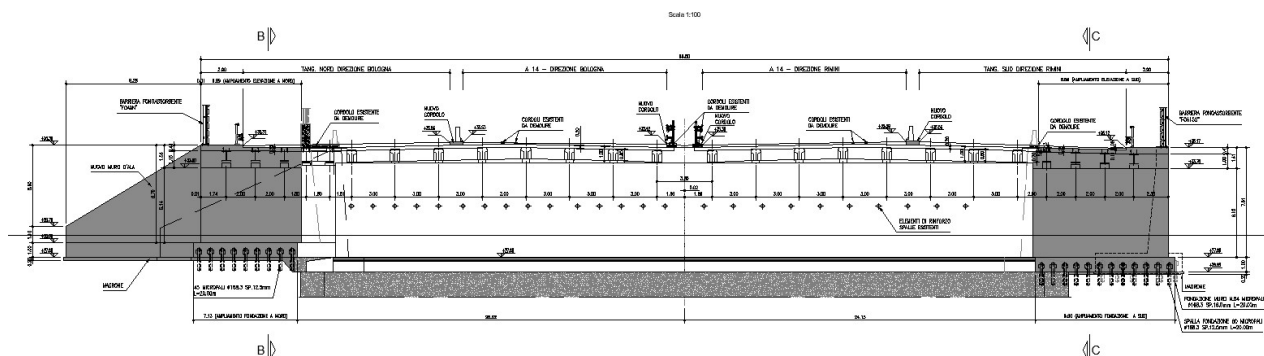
Prospetto Spalla Rimini con ampliamenti
